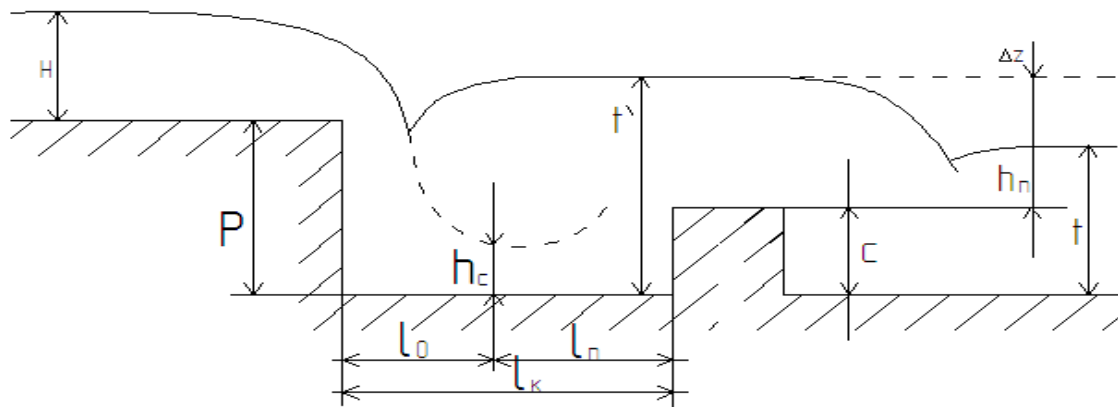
расчетные схемы водобойного колодца (а) и водобойной стенки (б)
